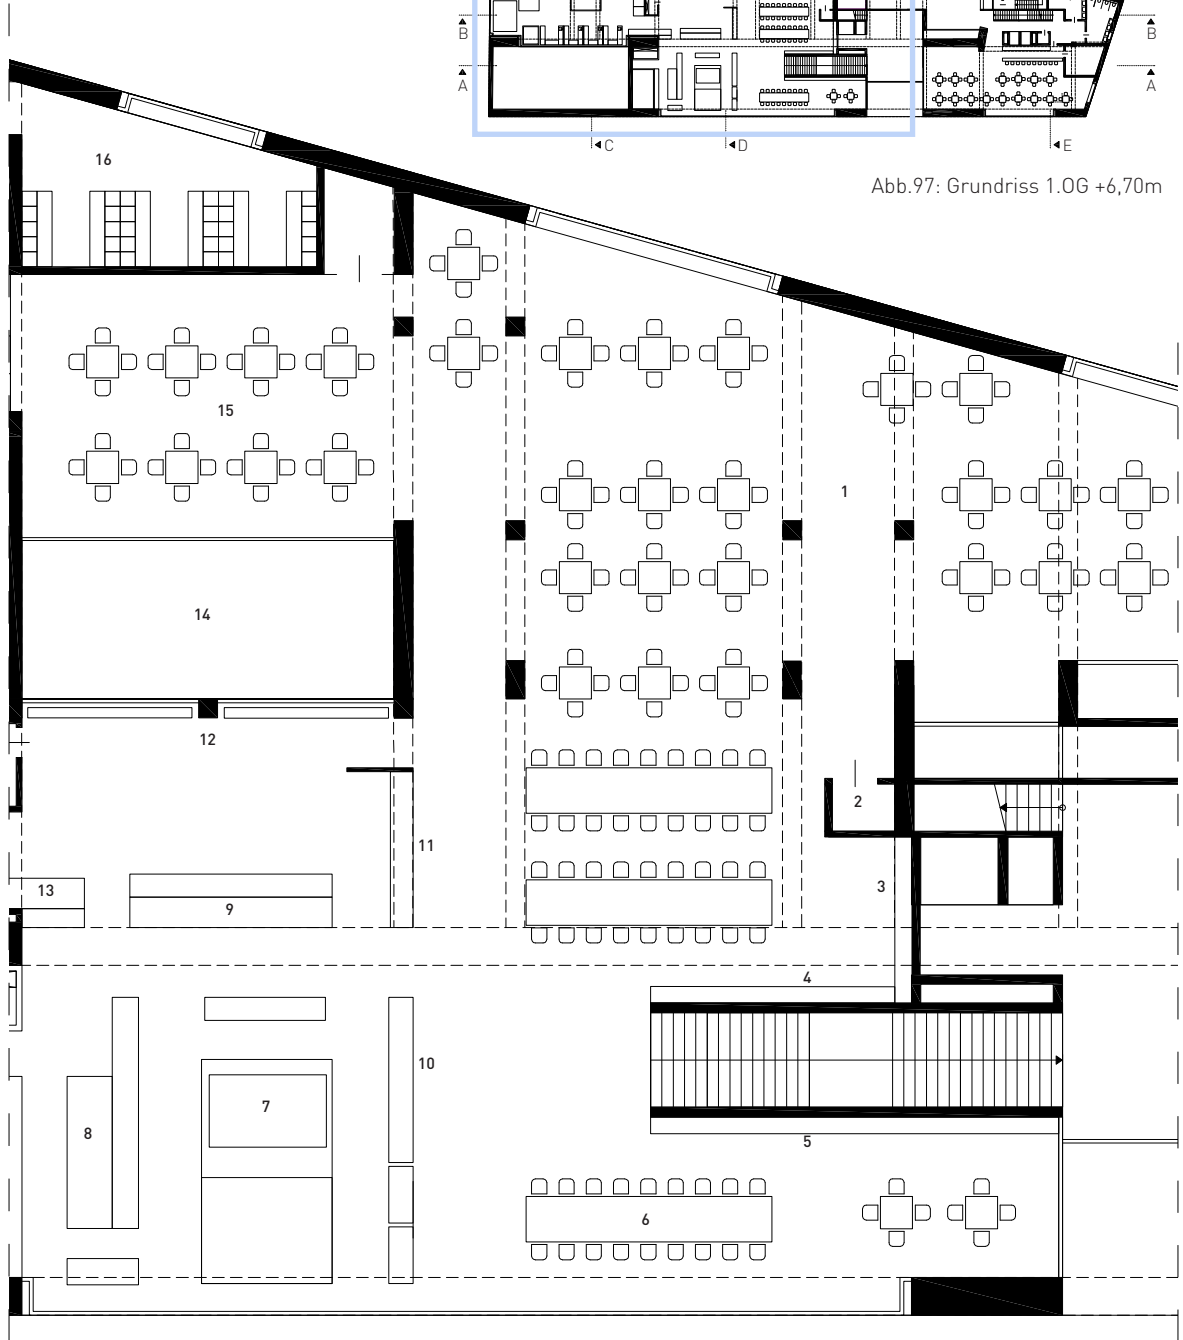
Grundriss Gastraum und Küche M1:200
